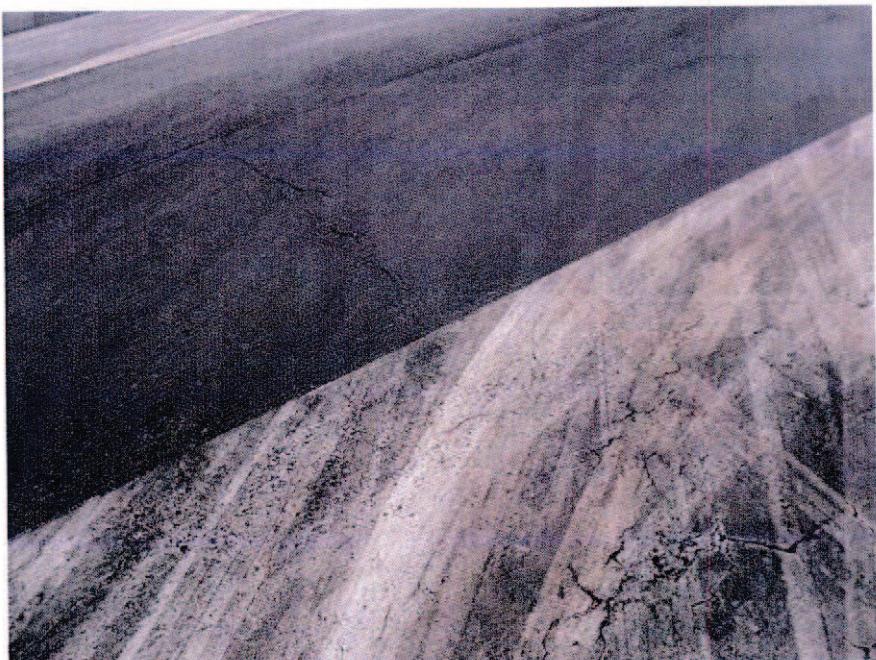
Fissuras Longitudinais (próximas a cabeceira 21)
